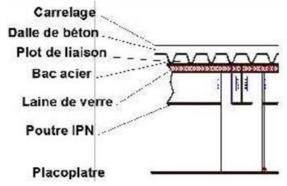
Détail n°03: Détail Plancher collaborant (1/25) Source : Auteurs.
